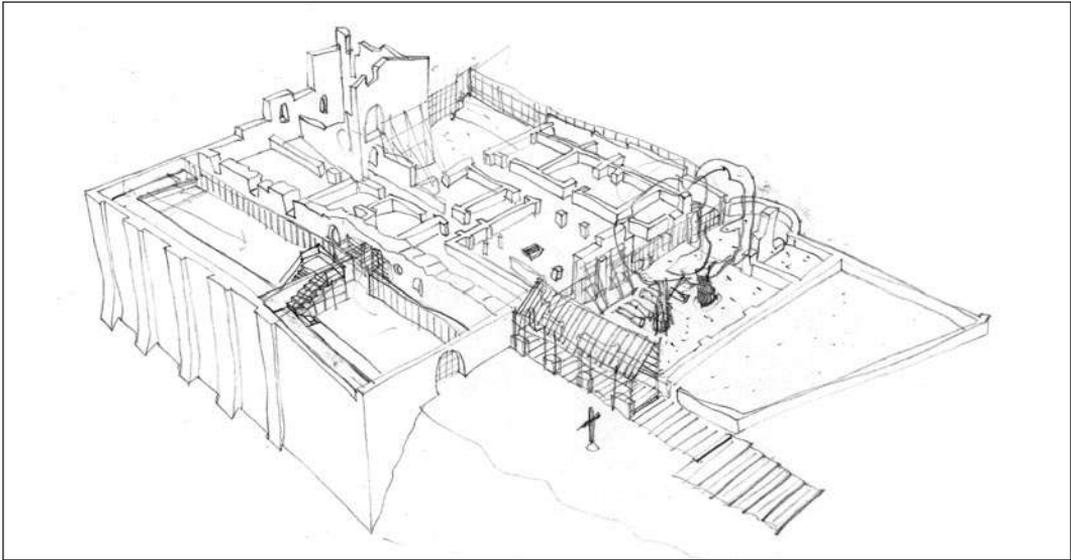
Più Studi Architettura, Progetto definitivo: schizzo prospettico, 2010
